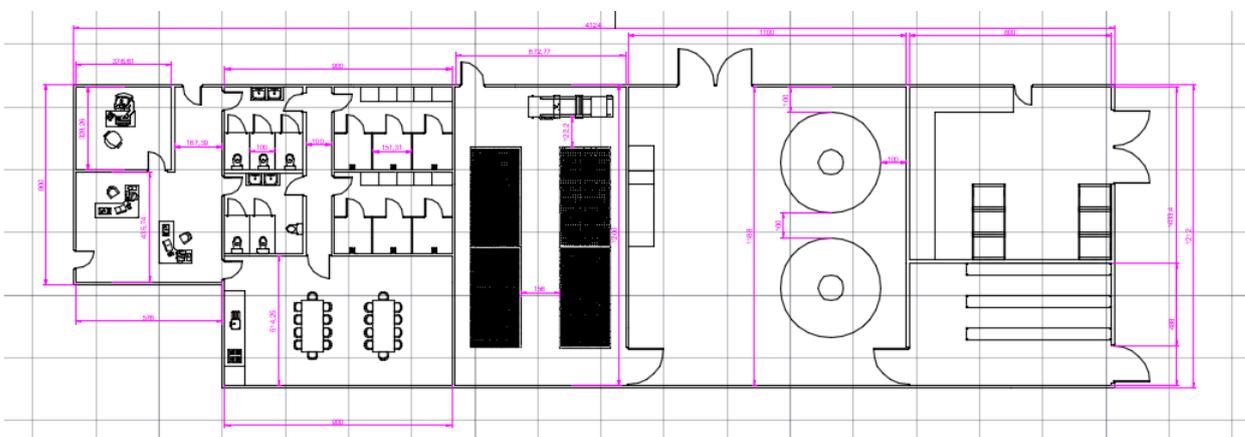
Plano de infraestructura. Fuente: Elaboración propia.
